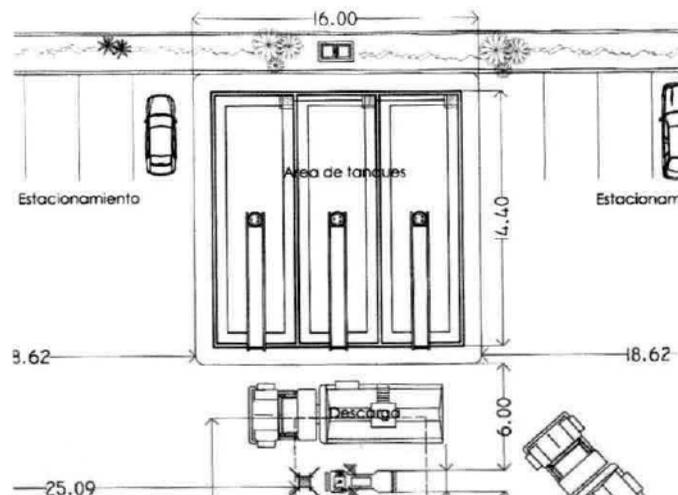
Plano de localización de los tanques para almacenamiento de Diesel.
